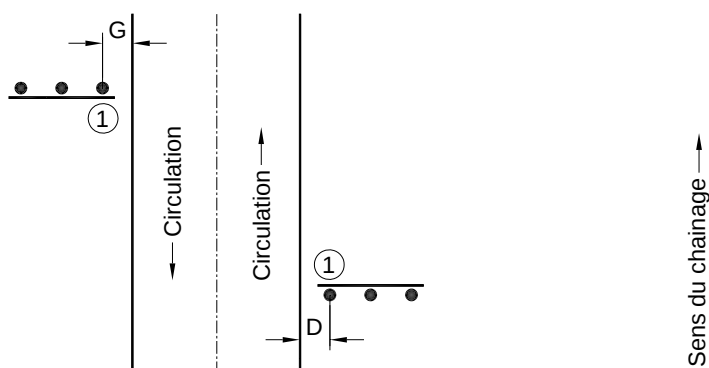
a) Dégagement latéral droit et gauche des structures de signalisation latérale sur chaussée unique
